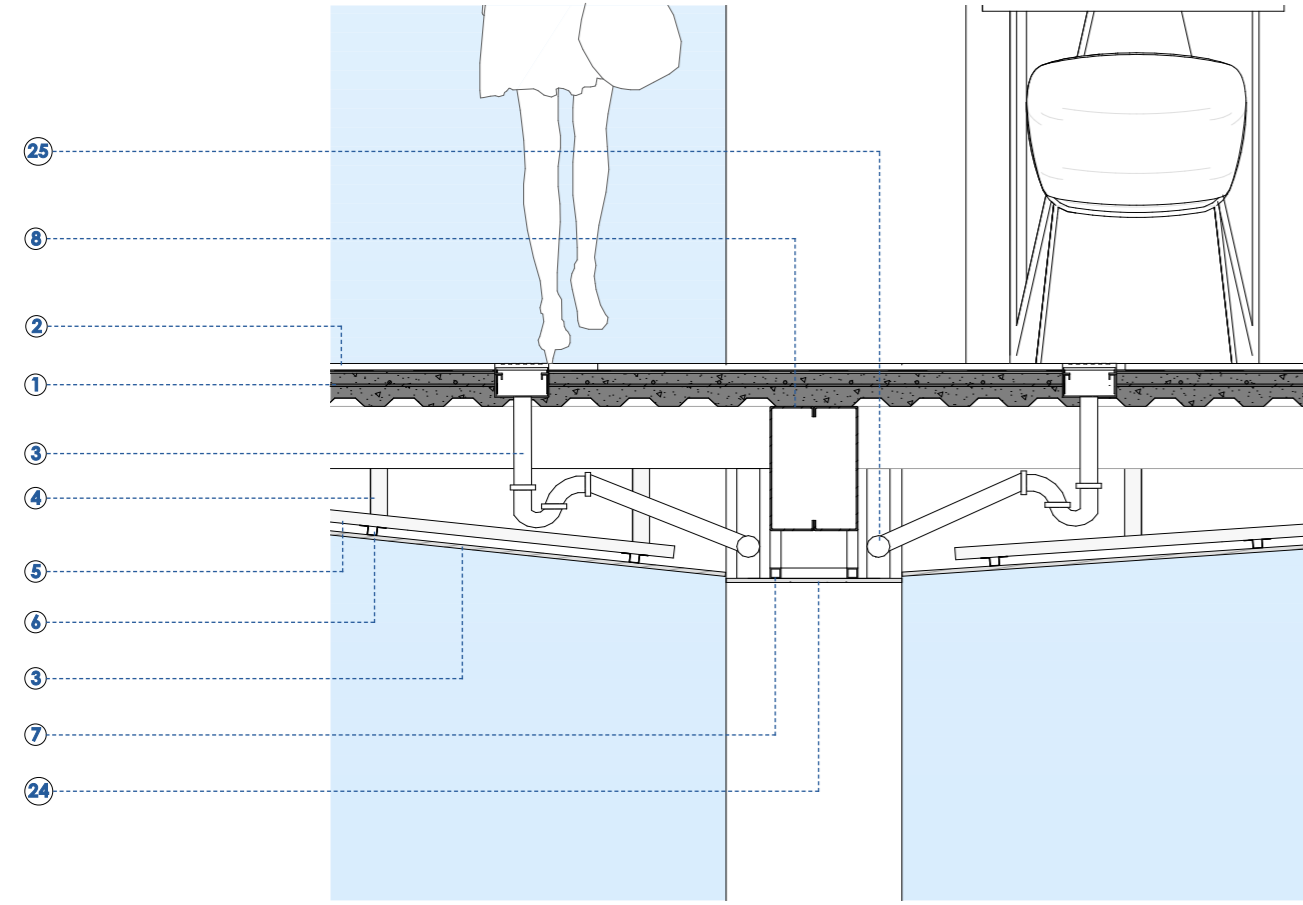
Detalle Constructivo C-1. Fuente: Elaboración propia (2026)
